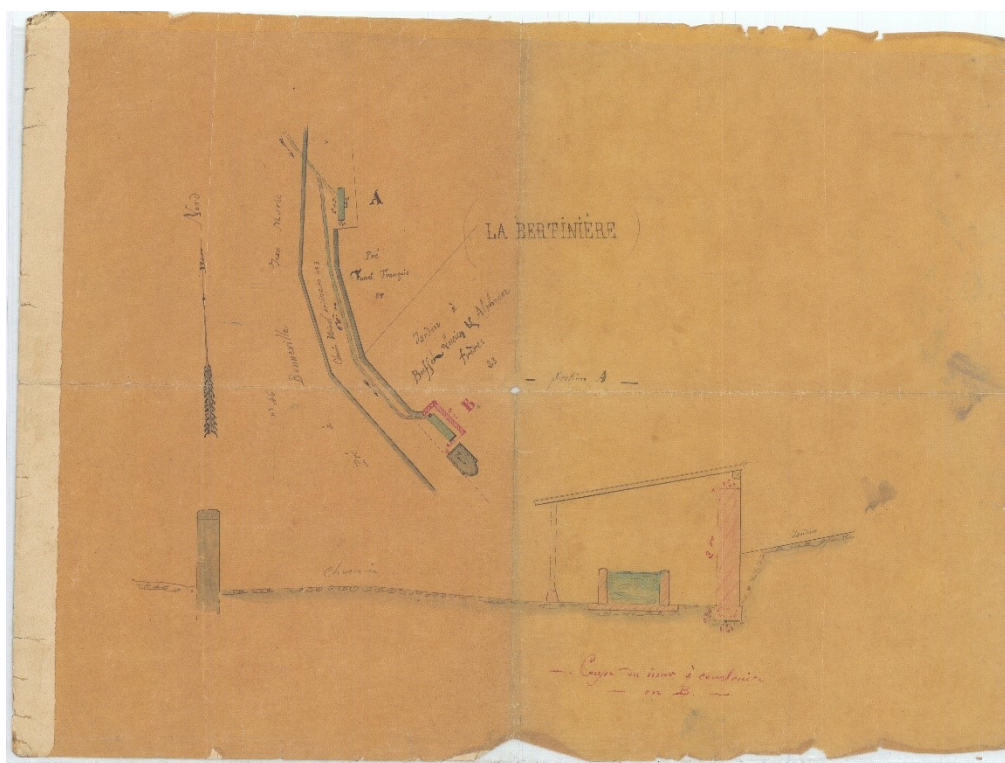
Plan pour la construction d'un bac-lavoir aux abords du four banal au hameau de La Bertinière: plan (1890), 1M3
